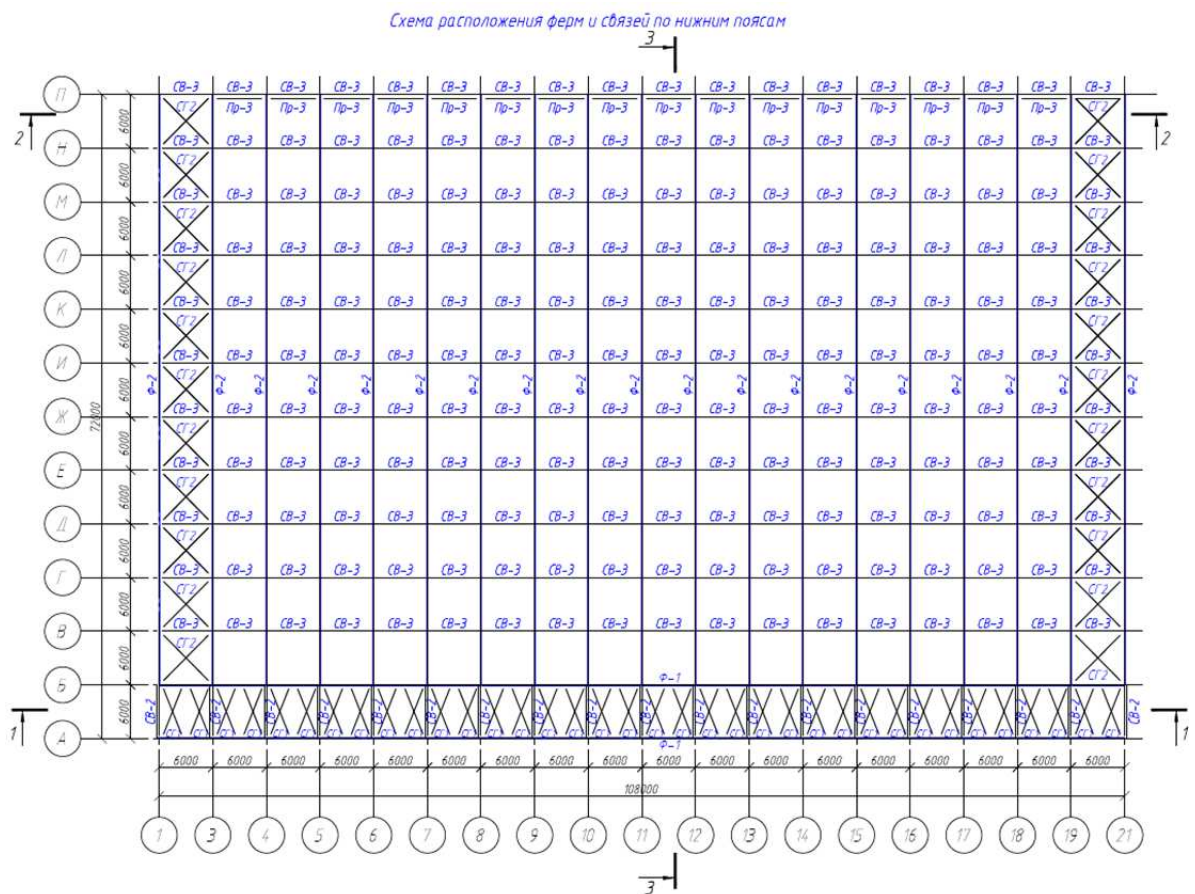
Схема расположения ферм и связей по нижним поясам
